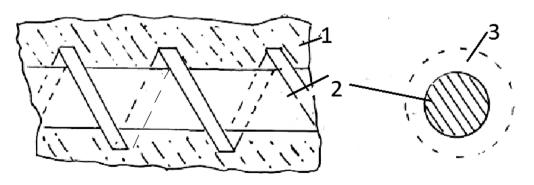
1 – Бетон; 2 – стержень с резьбой (3) Fig. 7. 1 – Concrete; 2 – threaded rod (3)
